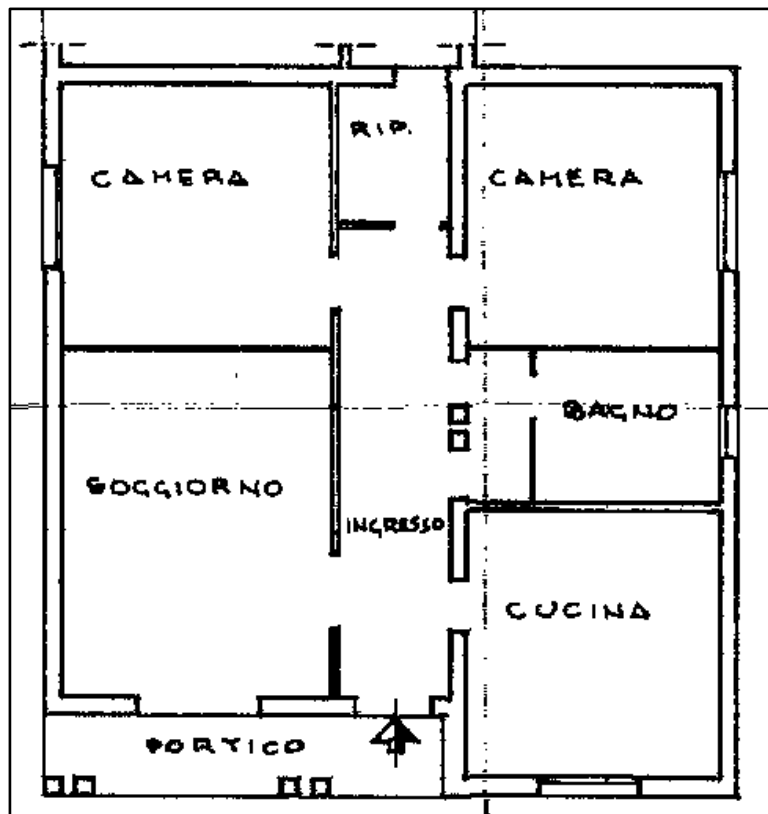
Destinazioni d'uso riportate nella planimetria catastale
